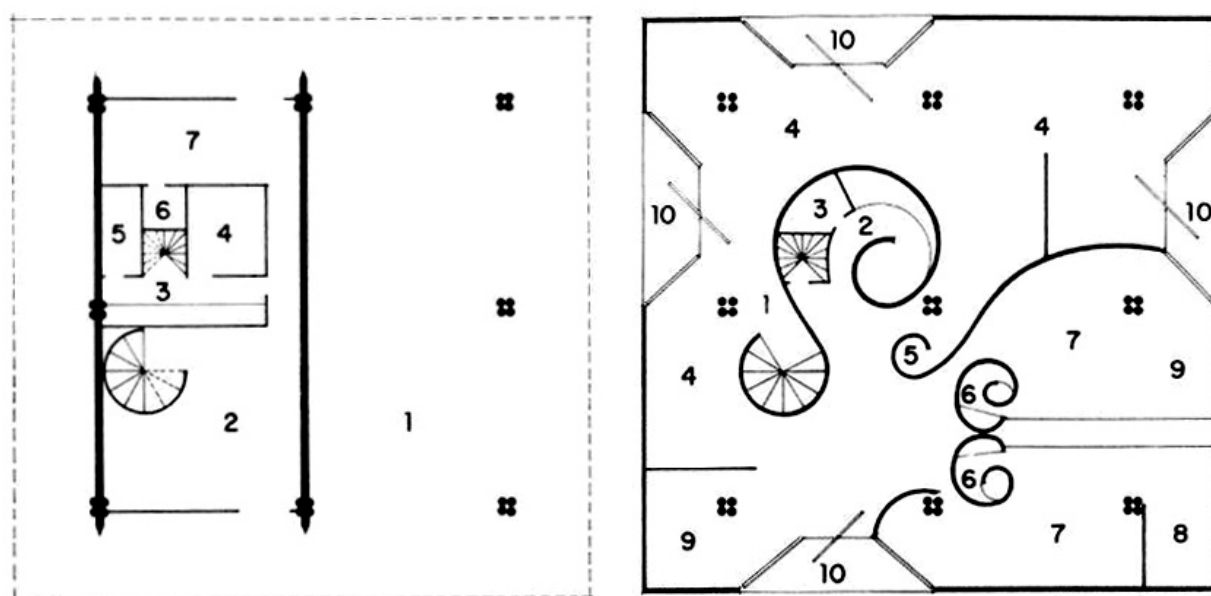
Casa Abrão Assad (1979); planta pavimento térreo; 1) abrigo para veículos; 2) hall; 3) cozinha/ lavanderia; 4) quarto empregada; 5) banheiro; 6) lavabo; 7) estar.
